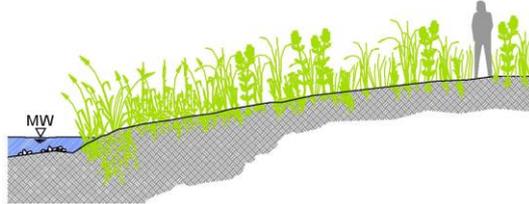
Uferböschung ohne Verbau mit unmittelbar anstehendem Boden, Bewuchs kann als Hochstaudenflur entwickelt werden (Grafik: STOWASSERPLAN)
